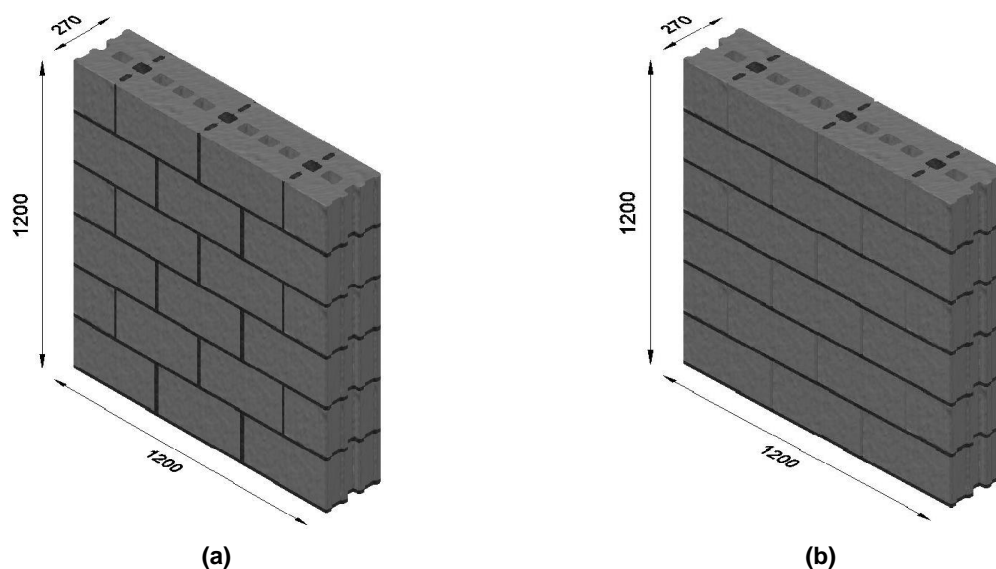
Dimensões do provete para ensaio de compressão diagonal (corte) (dimensões em mm): (a) Provete tipo I; (b) Provete tipo II.
